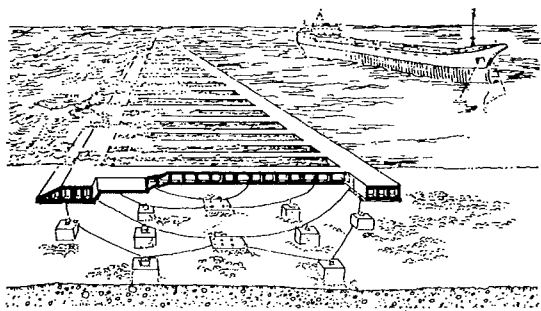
Frangiflutto galleggiante con ormeggi al fondale.
